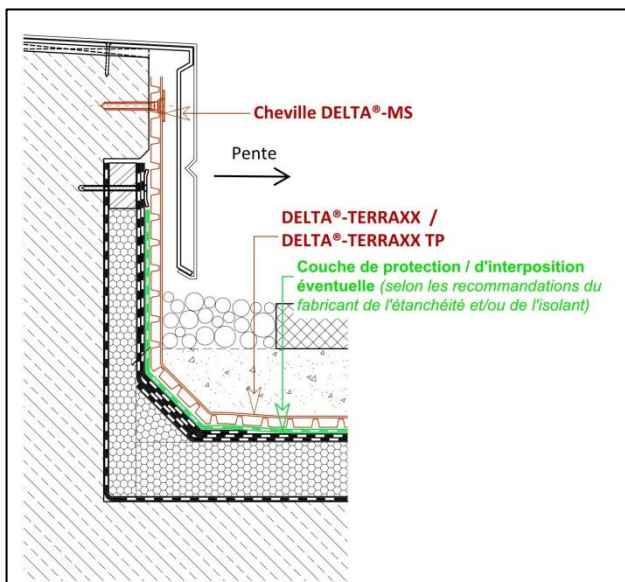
traitement des relevés en acrotère avec membrane d'étanchéité bitumineuse + DELTA®-TERRAXX / DELTA®-TERRAXX TP (protection lourde avec dalles ou pavés) – exemple 2
